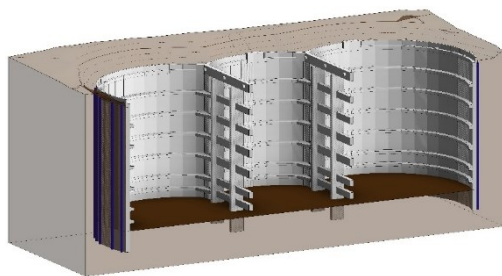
Corte longitudinal da estrutura do reservatório após toda a escavação do interior e execução dos anéis e estroncas.
